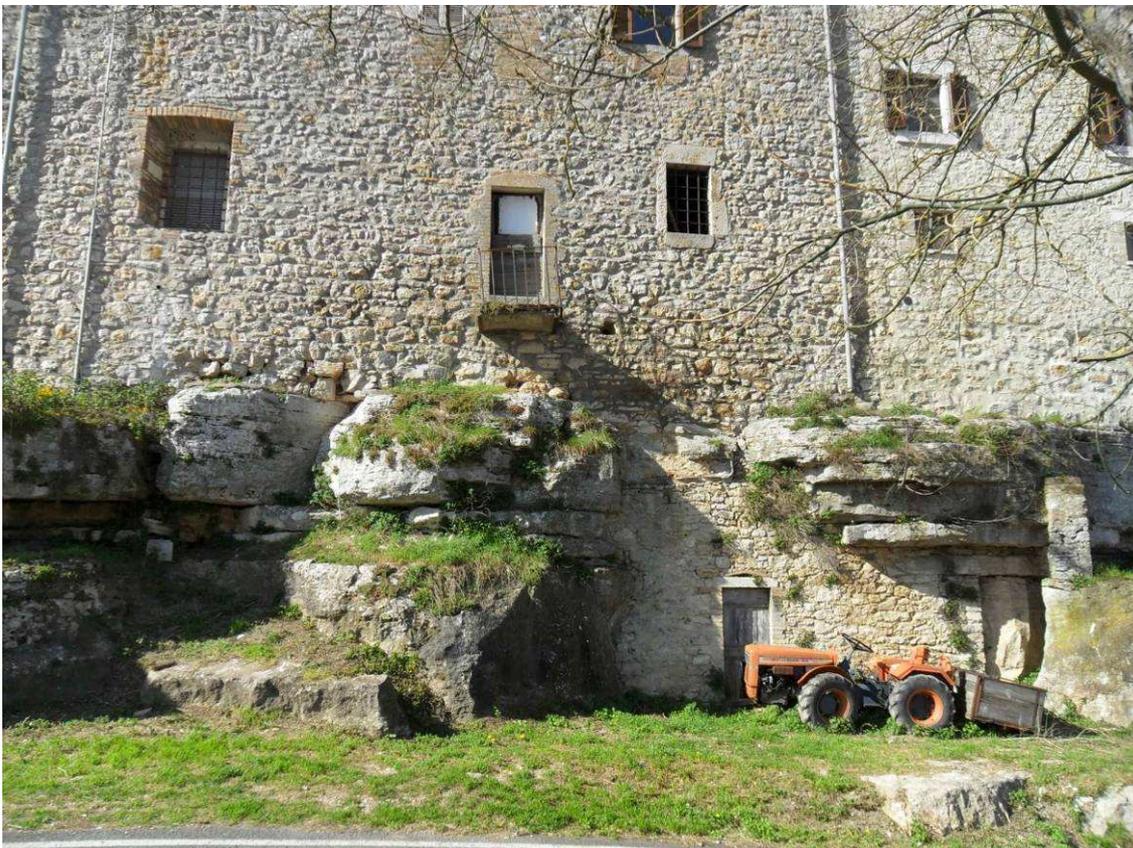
Prospetto edifici che affacciano sulla pubblica viabilità
